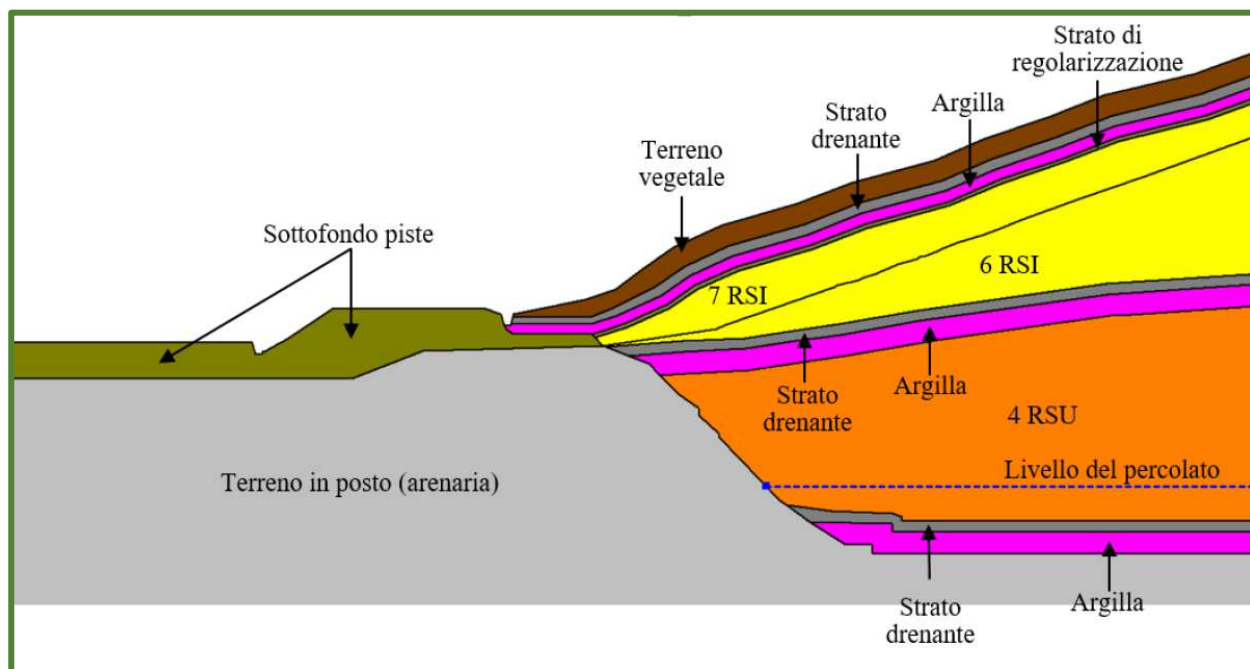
/VIII – Sezione B-B'' – Particolare 1
